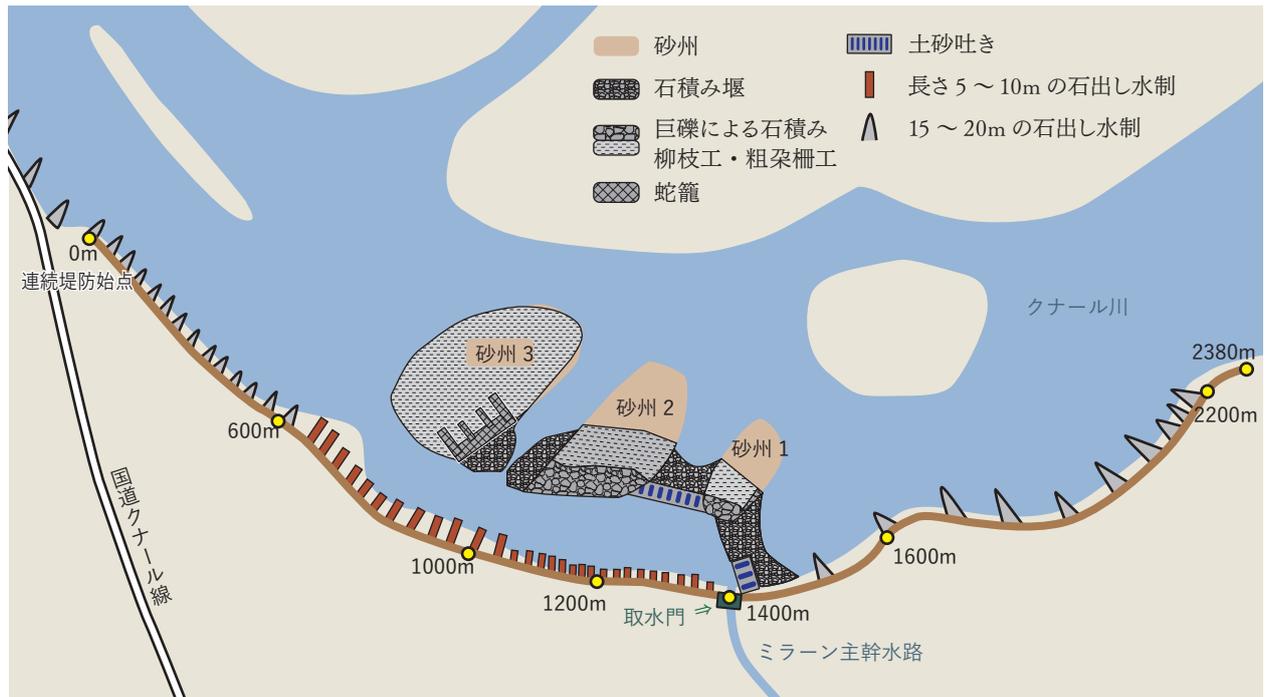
ミラーン堰全体平面図<sup>2)</sup>
